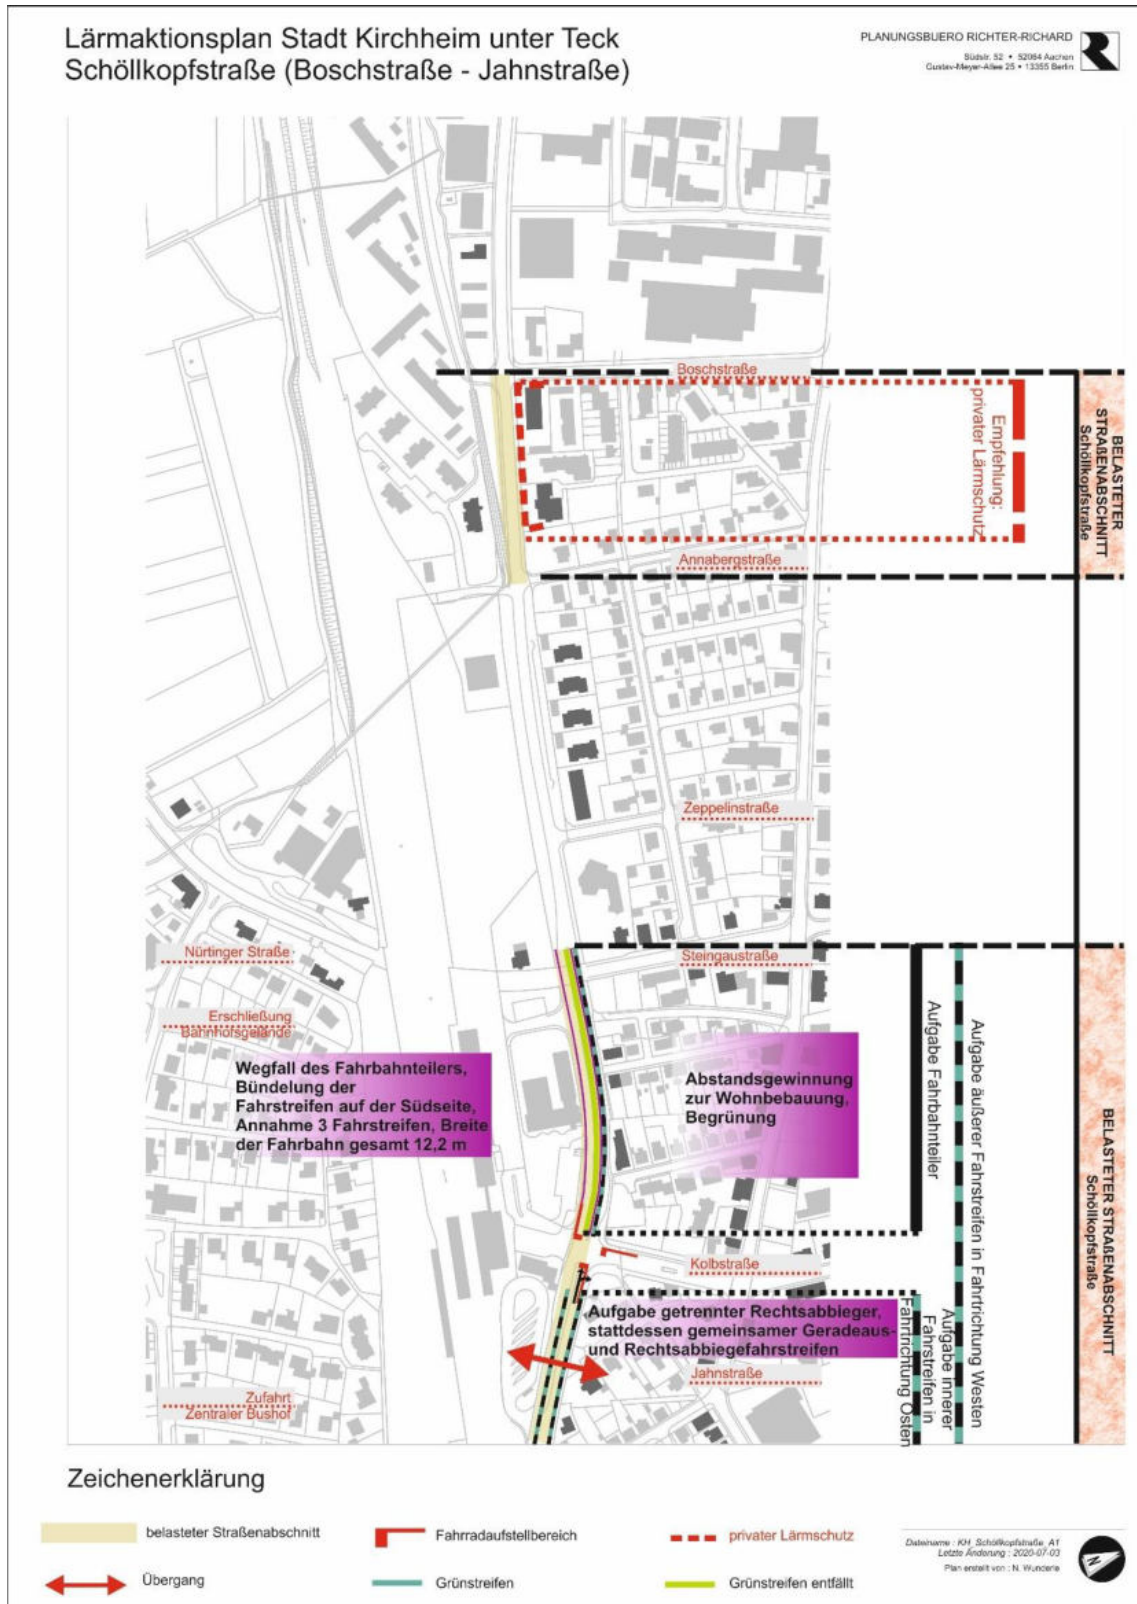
Schöllkopfstraße (Boschstraße – Jahnstraße)
